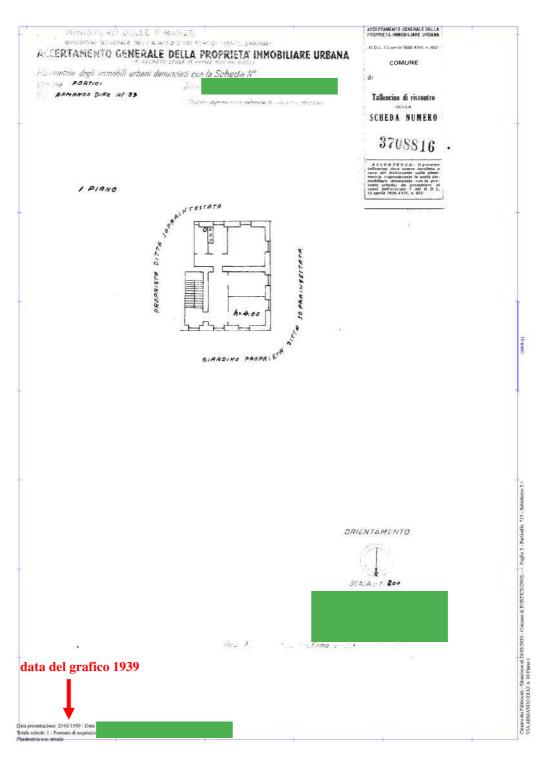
Prima planimetria catastale dell'appartamento pignorato (fuori-scala)
